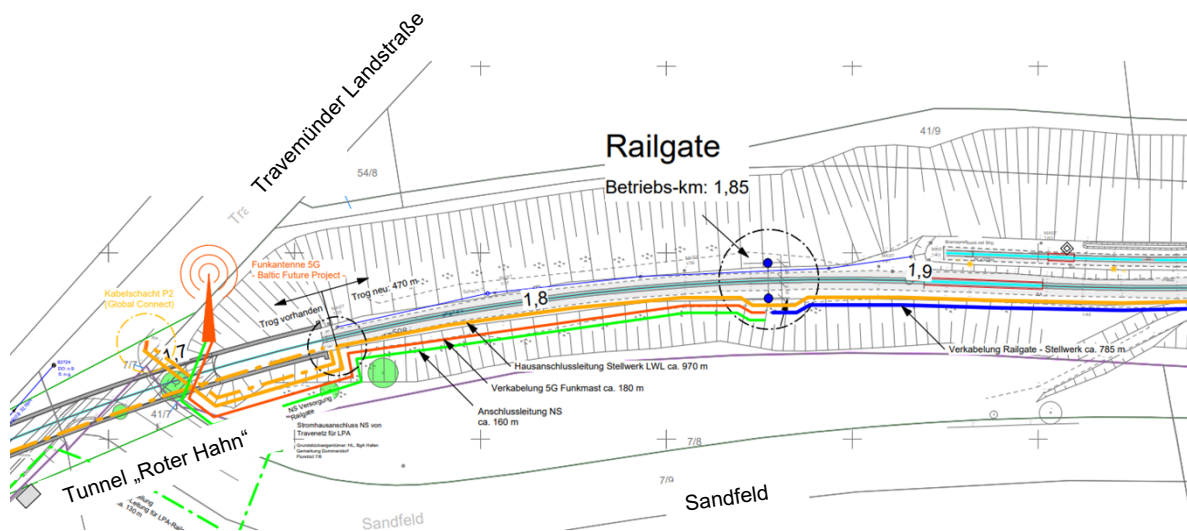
Lageplan der Scanneranlage im Betriebsbahnhof Lübeck-Skandinavienkai (Zeichnung genordet) o.M.
